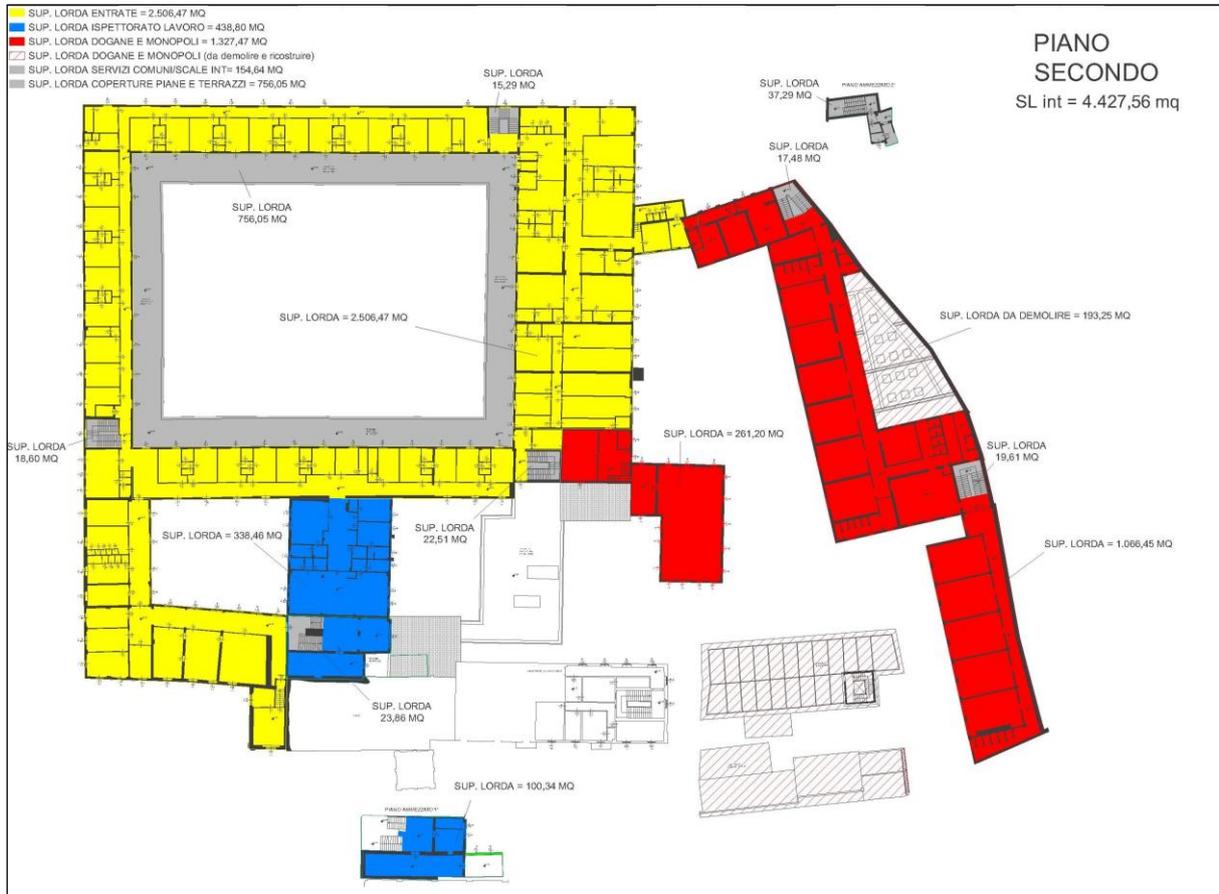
Piano di razionalizzazione (2019) – pianta del piano secondo
